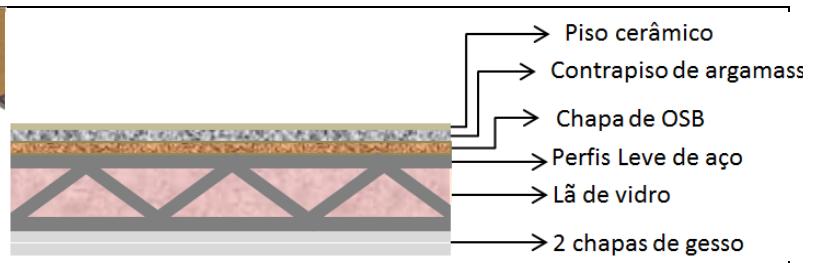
Corte do sistema de piso – treliça metálica, placas de OSB e contrapiso de argamassa
